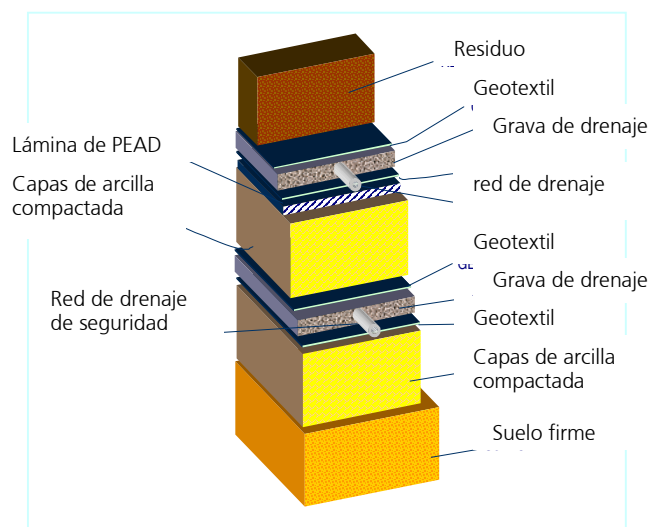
Corte transversal de la impermeabilización y red de drenaje
